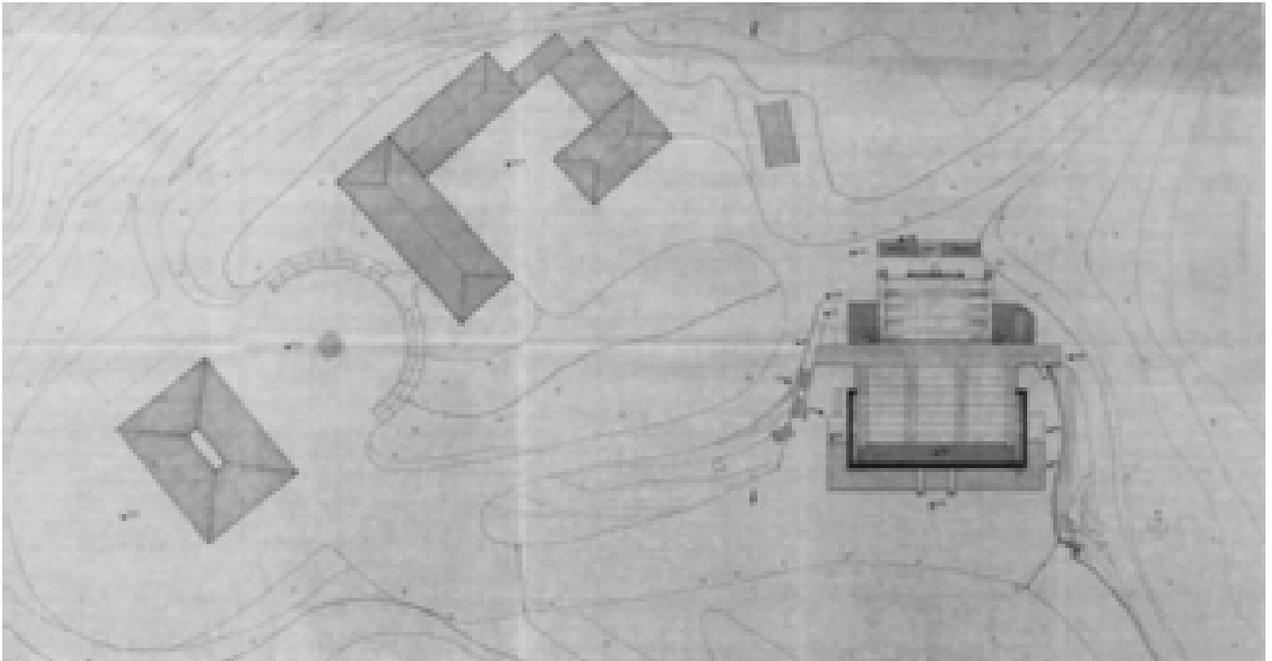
Planimetria generale, opere di completamento – 22/04/1997 (AABS-522)
